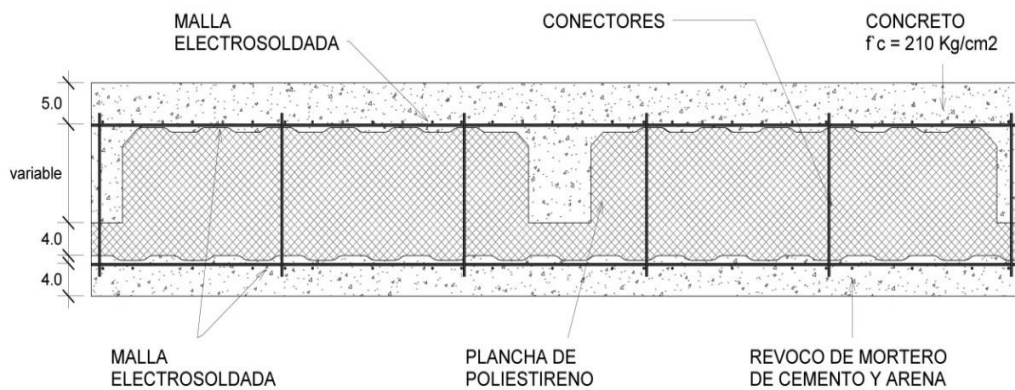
Panel forjado con dos nervaduras para armado de viga PL2
